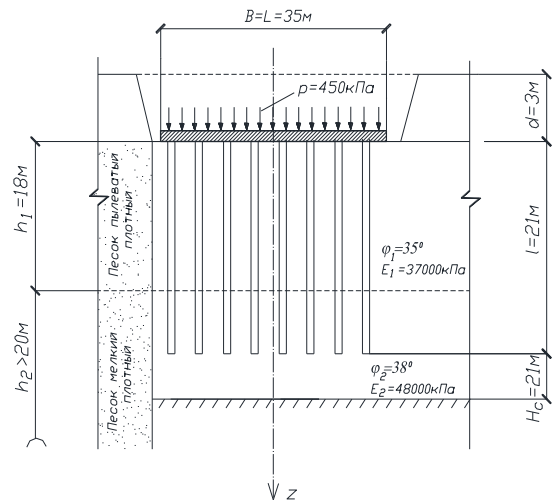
Вариант заложения свайно-плитного фундамента в ИГЭ-2
